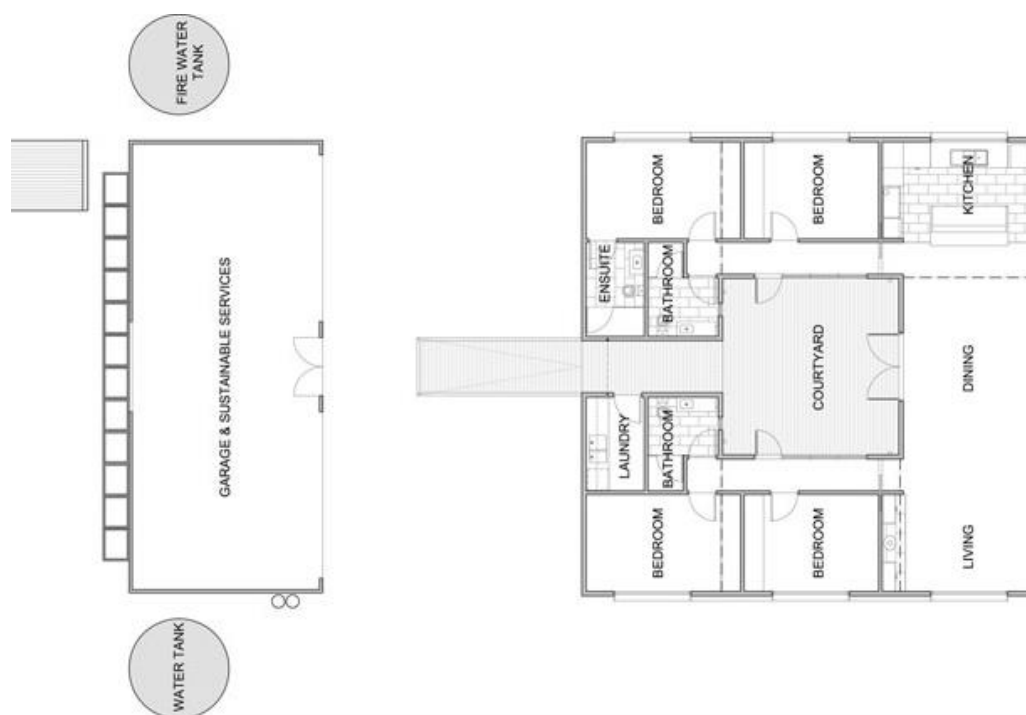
Planta da *French Island*, Austrália- EcoLiv.
